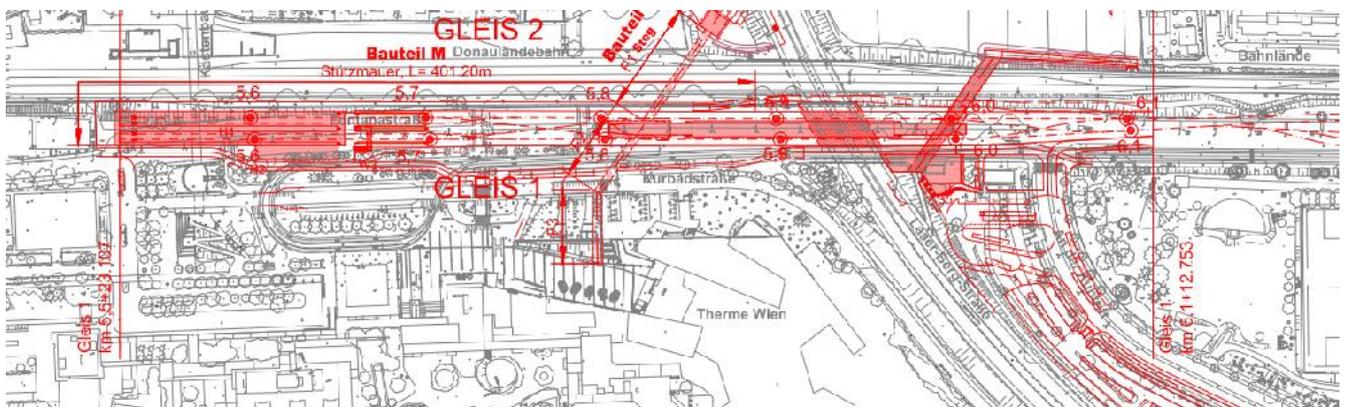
Übersichtslageplan – Bauabschnitt U1/15²²²
